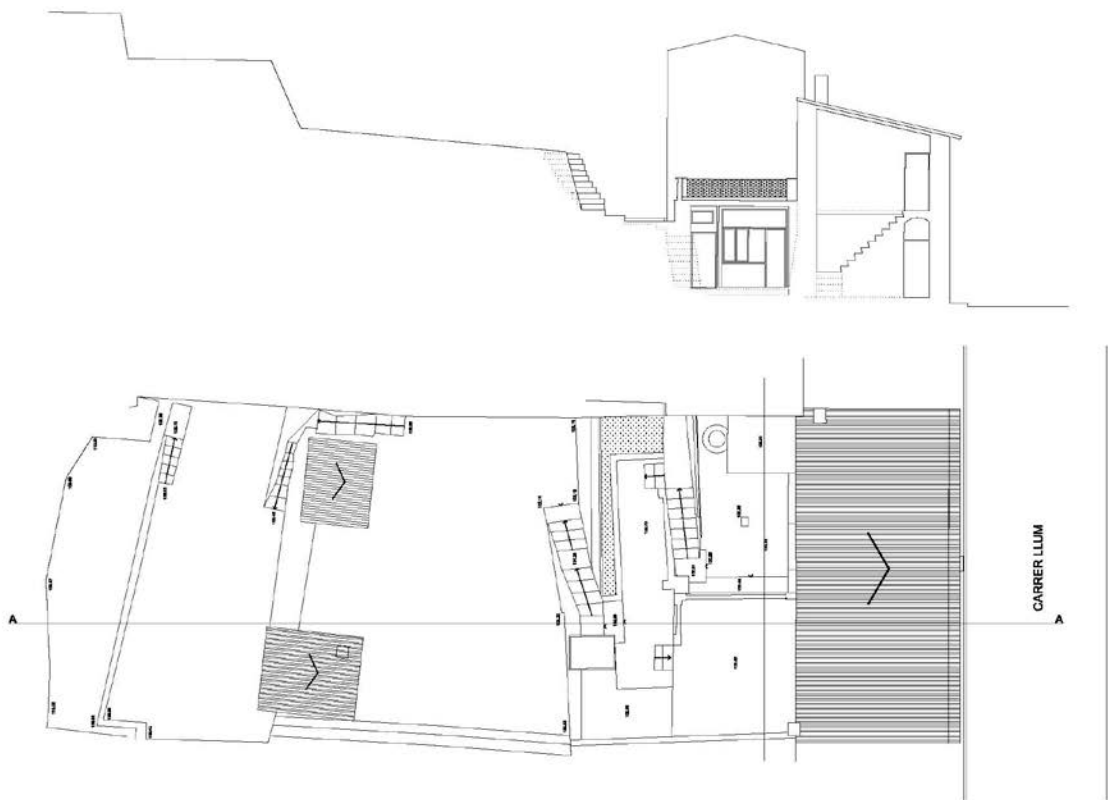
Planta y sección de la edificación y de la parte urbana de la parcel. Estado actual.
